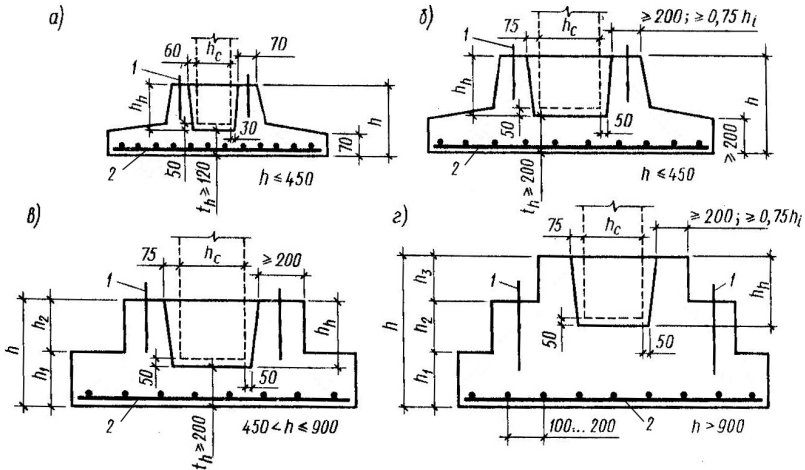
Поперечный профиль и армирование сборных отдельных фундаментов под колонны: *а* – пирамидальный фундамент под стойку лоткового канала; *б* – пирамидальный фундамент под стойку производственного здания; *в, г* – ступенчатые фундаменты; *1* – монтажные петли; *2* – арматурная сетка
